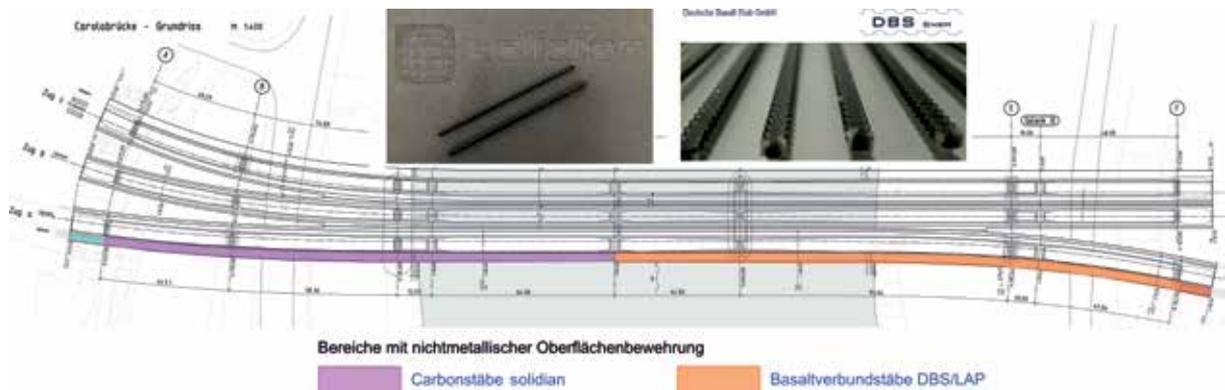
Aufteilung der nichtmetallischen Bewehrung
